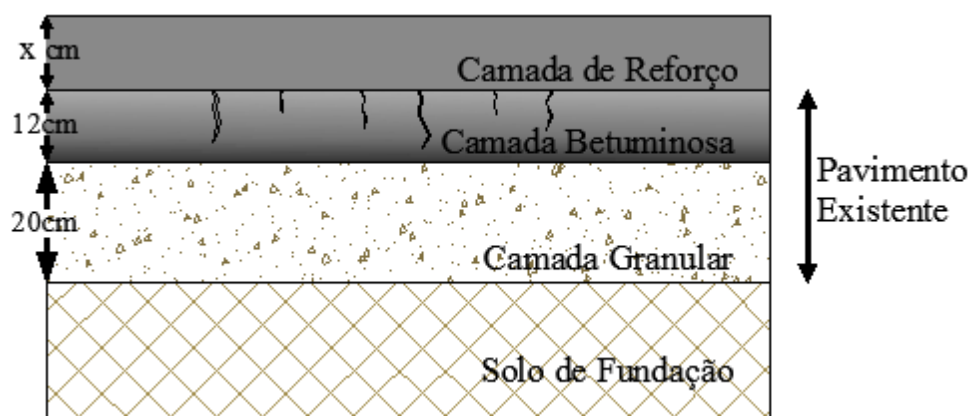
Aplicação da camada de reforço no pavimento auscultado
